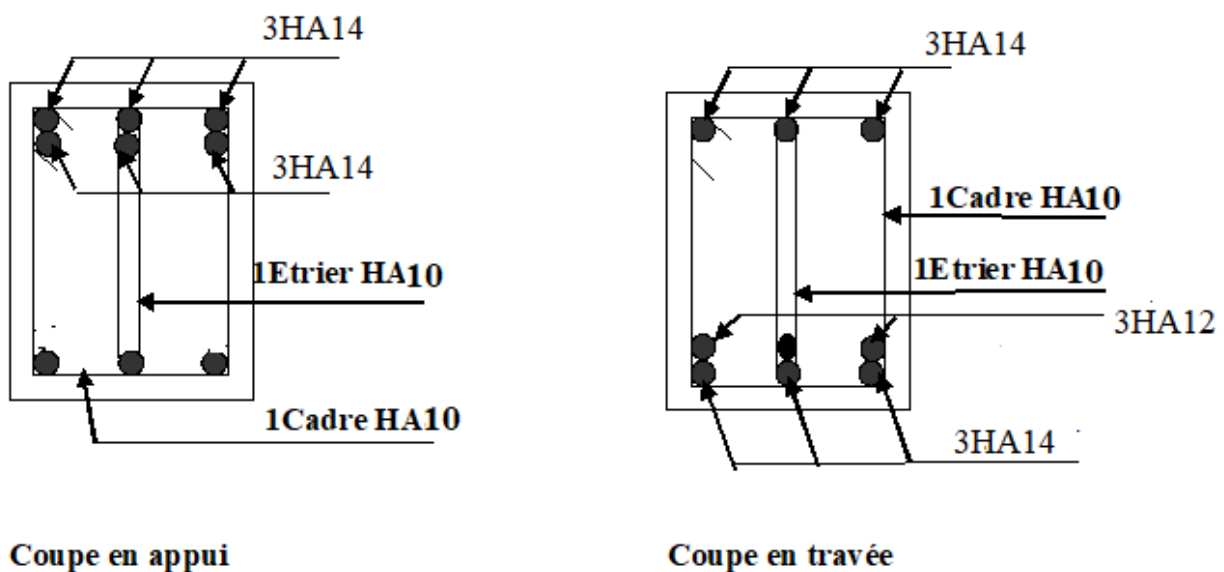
Schéma de ferrailage des poutres secondaire RDC.
